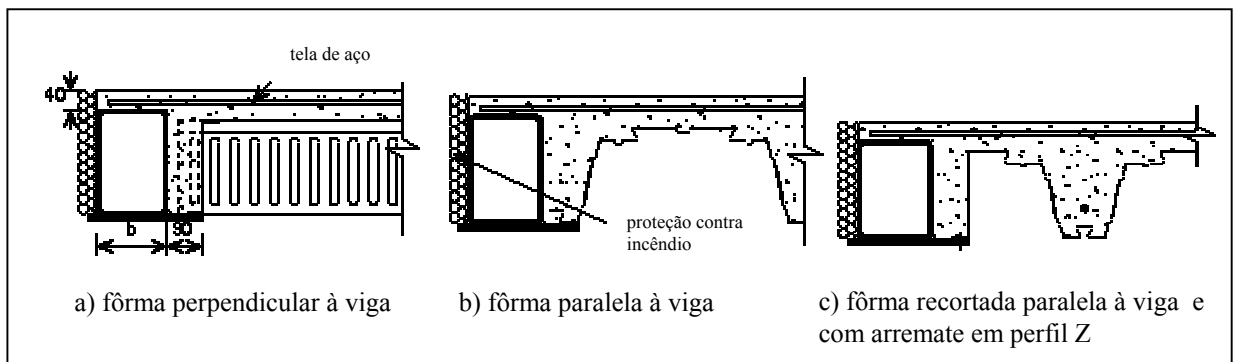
Viga de bordo em perfil retangular dimensionada como viga de aço isolado (Fonte catálogo da CORUS)
